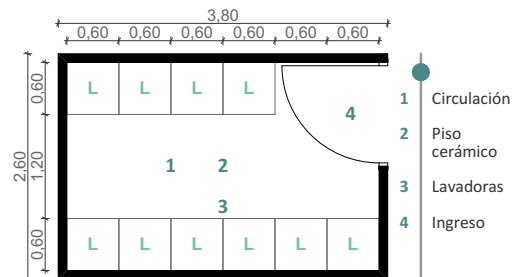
Planta cuarto de lavado. Fuente: Autores.
